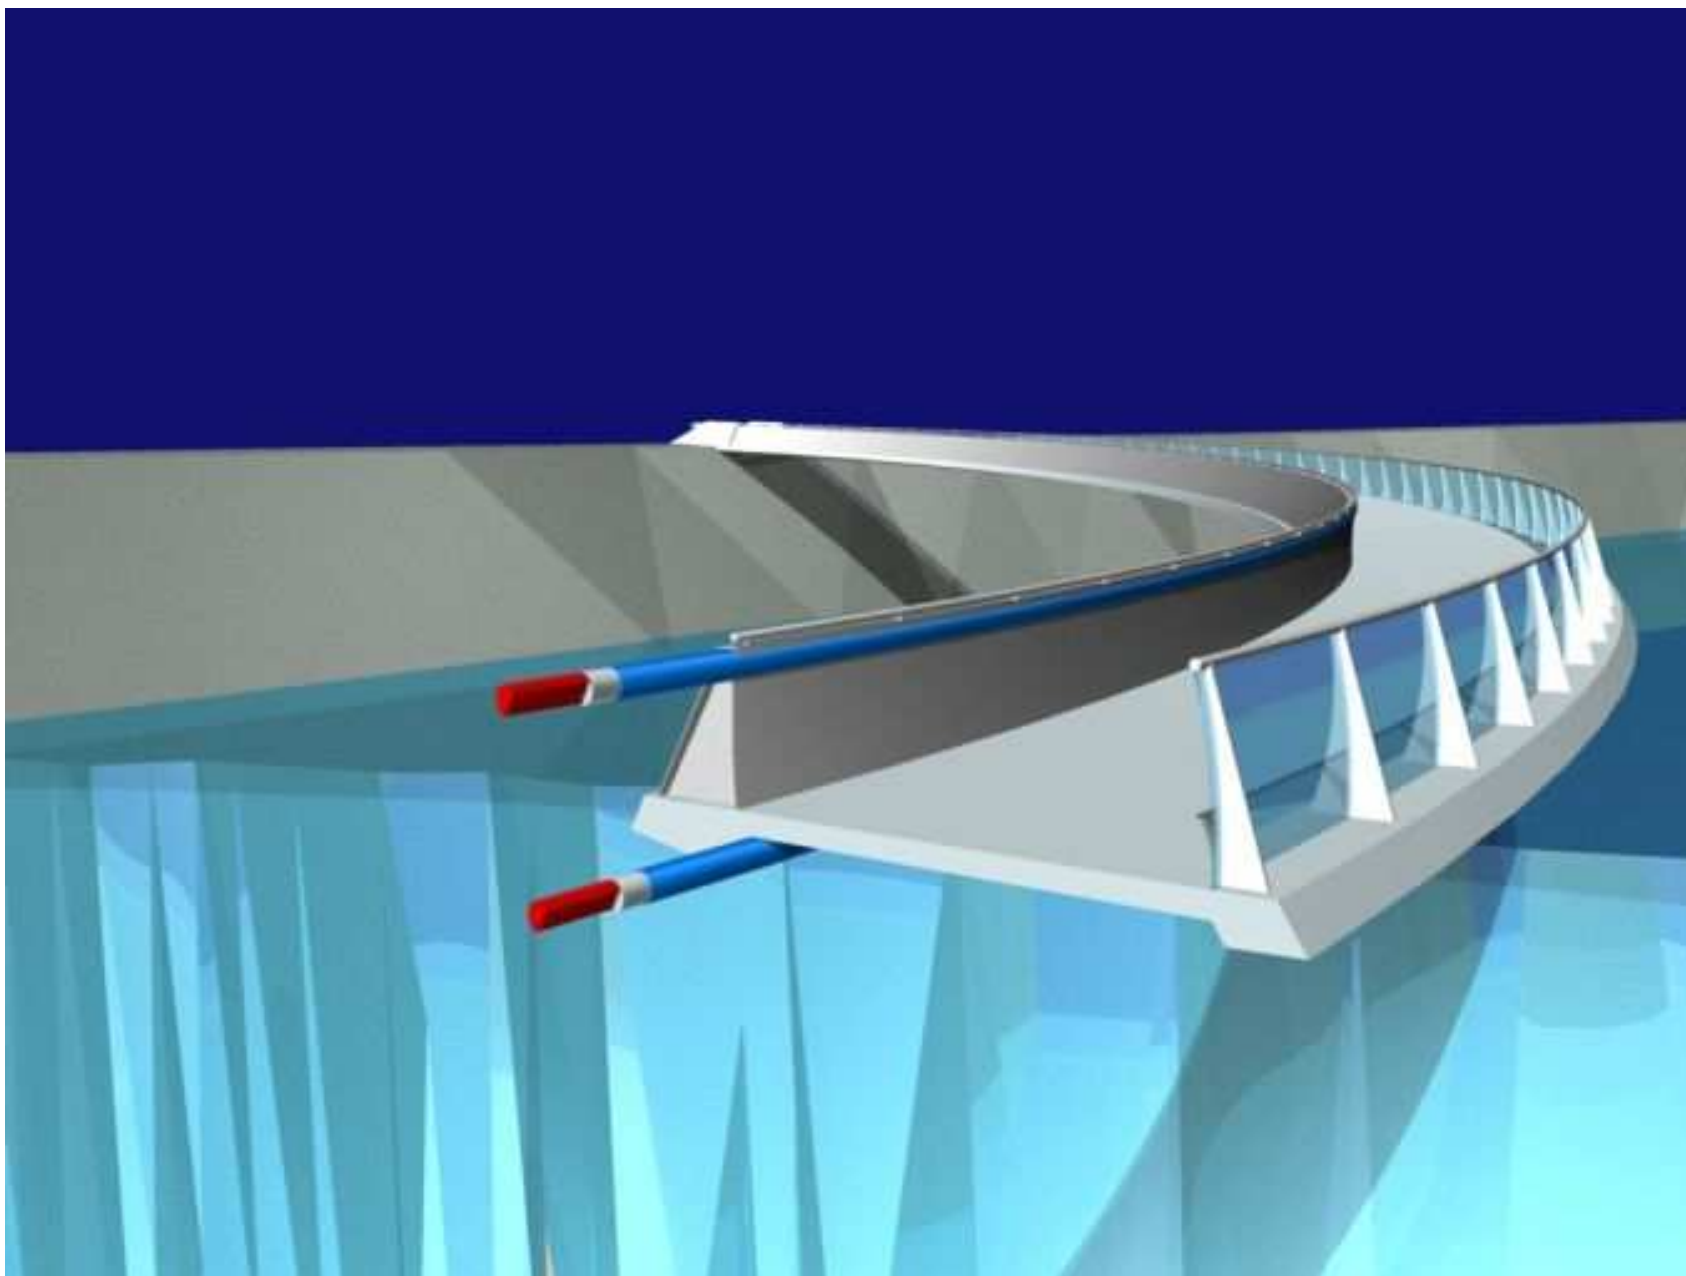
Vodorovné namáhání stěn komůrkových průřezů u silně zakřivených konstrukcí
